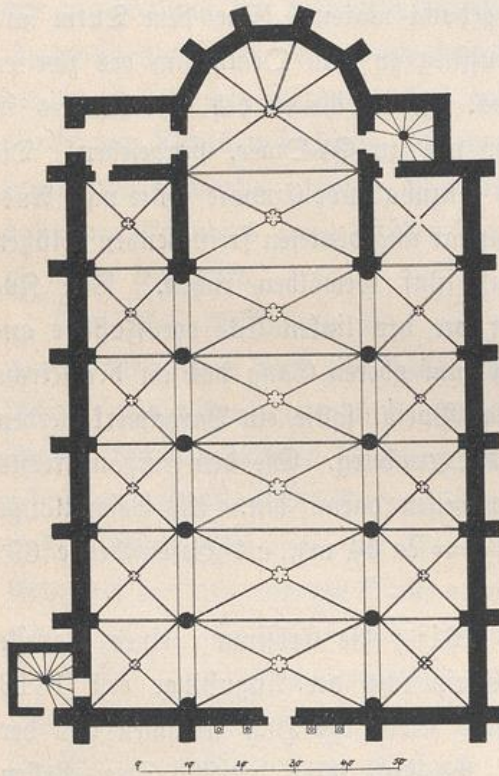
Huy. Du Blocqs Plan zu einer Kollegskirche.
